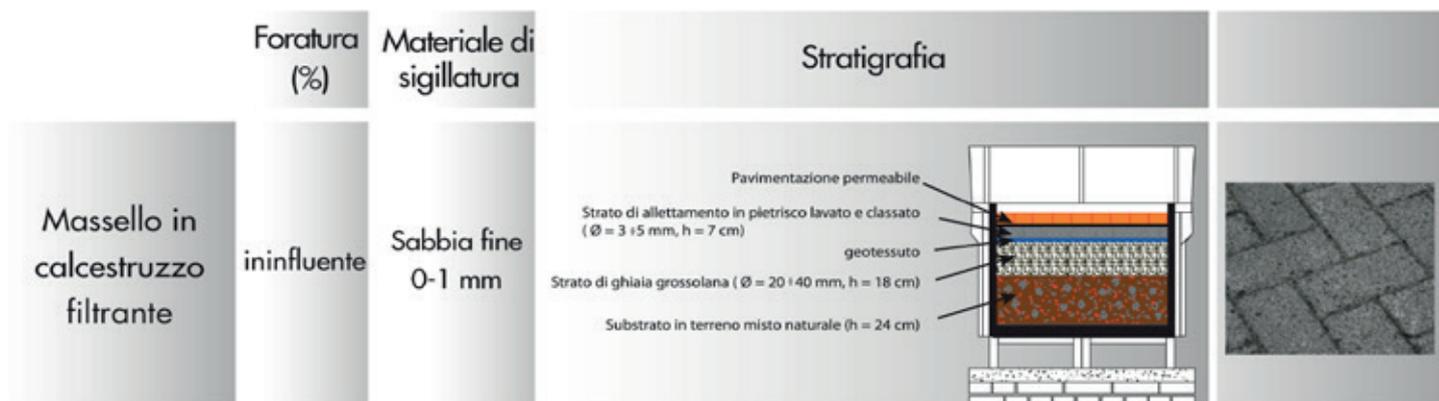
Fonte: Linee Guida per la determinazione della capacità drenante delle pavimentazioni modulari in calcestruzzo di Assobeton
